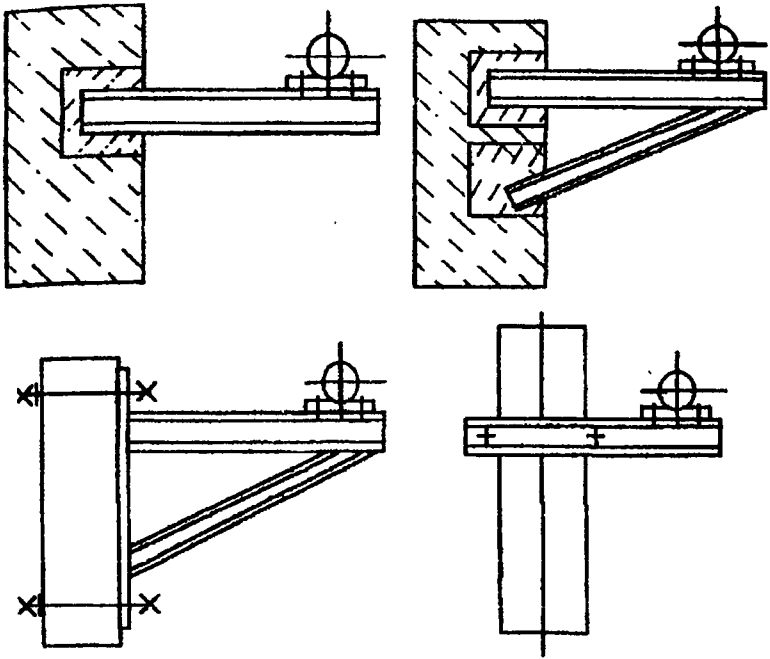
Крепление оборудования к стенам и колоннам
